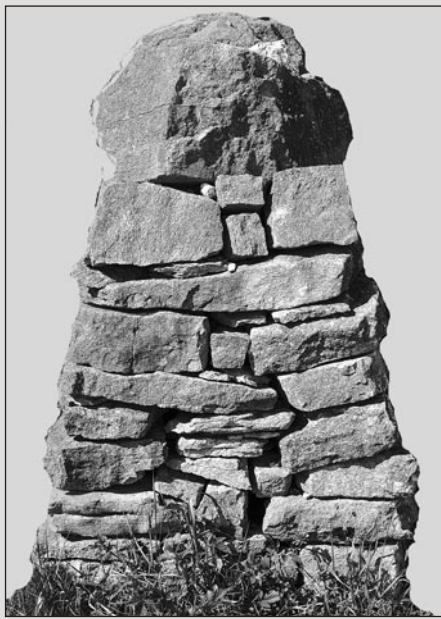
Lajoux (et du Jura). Mur en dalles dites nacrées.
